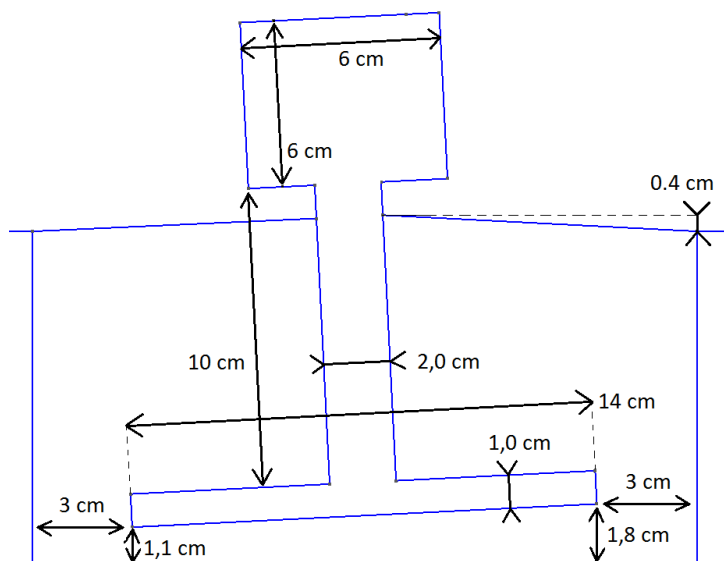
Géométrie et dimensions du rail et de la résine
